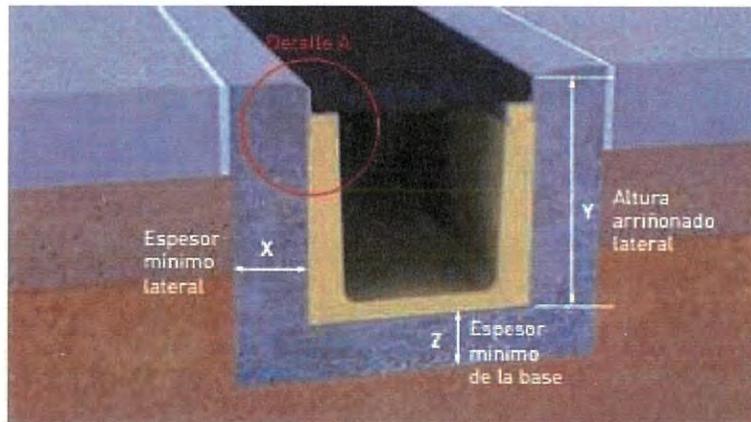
Construcción de dado para pavimento de concreto hidráulico
